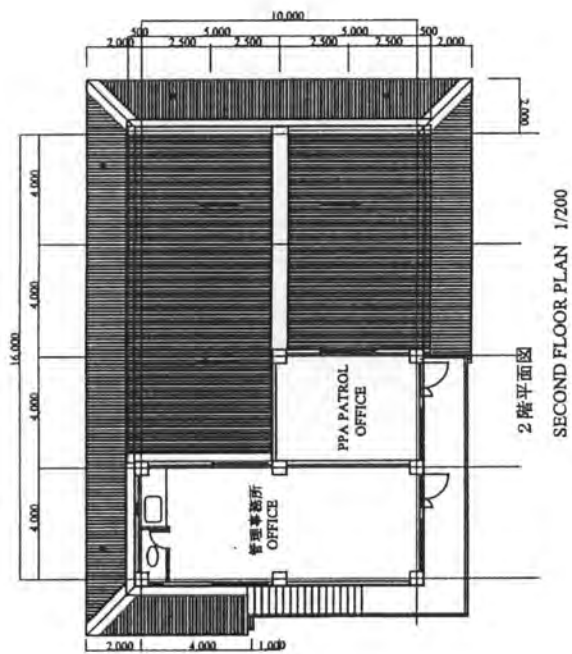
倉庫·管理事務所棟平面図、立面図
